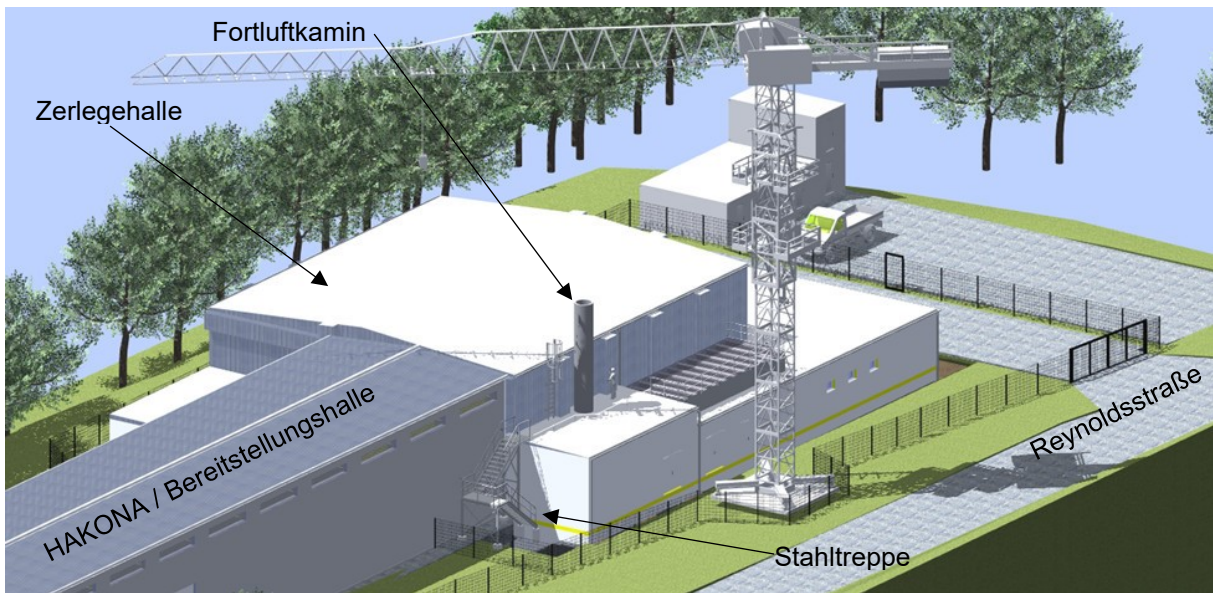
Dachabdichtung, Fassadenverkleidung und Montage der Außentreppe, Stahlbühne etc., Ansicht von Nord-Osten
